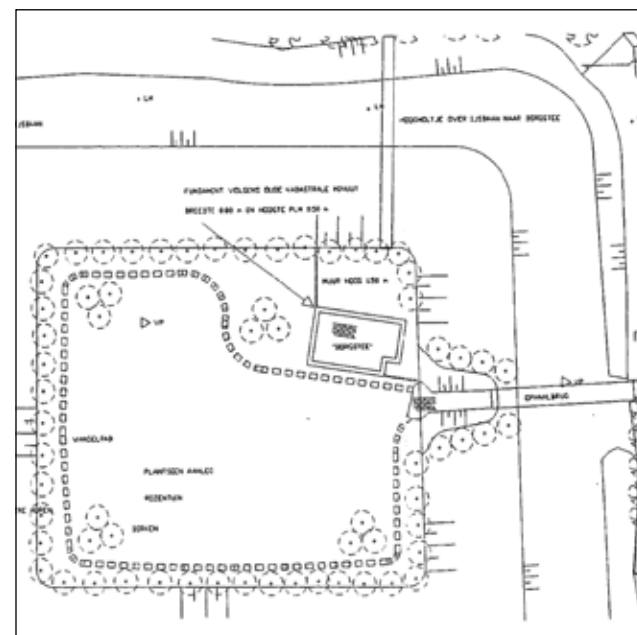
Plan voor de herinrichting van de Onstaborg (detail)
